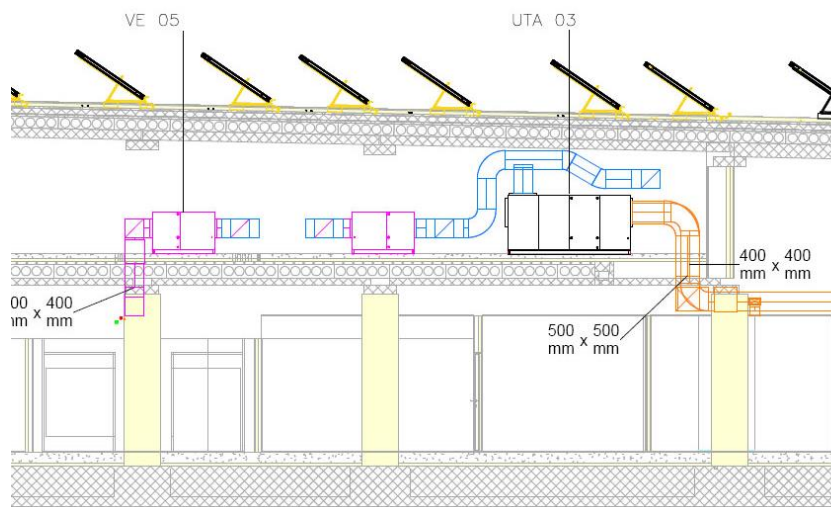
Fabbricato ATC piano terreno: sezione e unità di ventilazione su copertura
